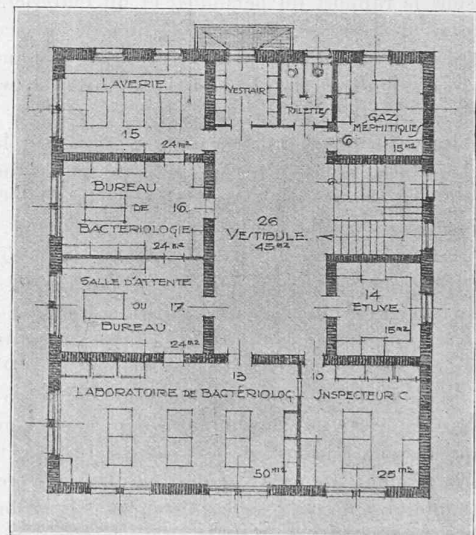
Plan du rez-de-chaussée. — 1 : 300.
